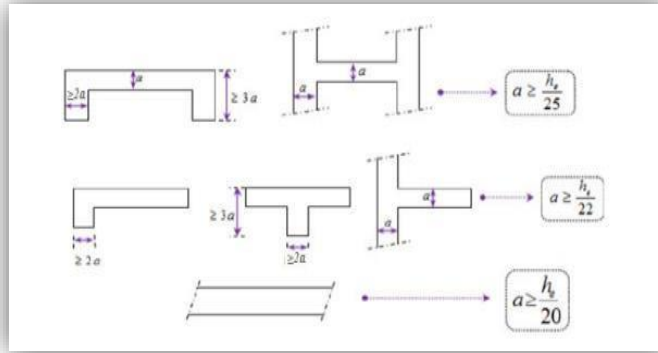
Coupe de voiles en plan. [RPA99/version2003]
